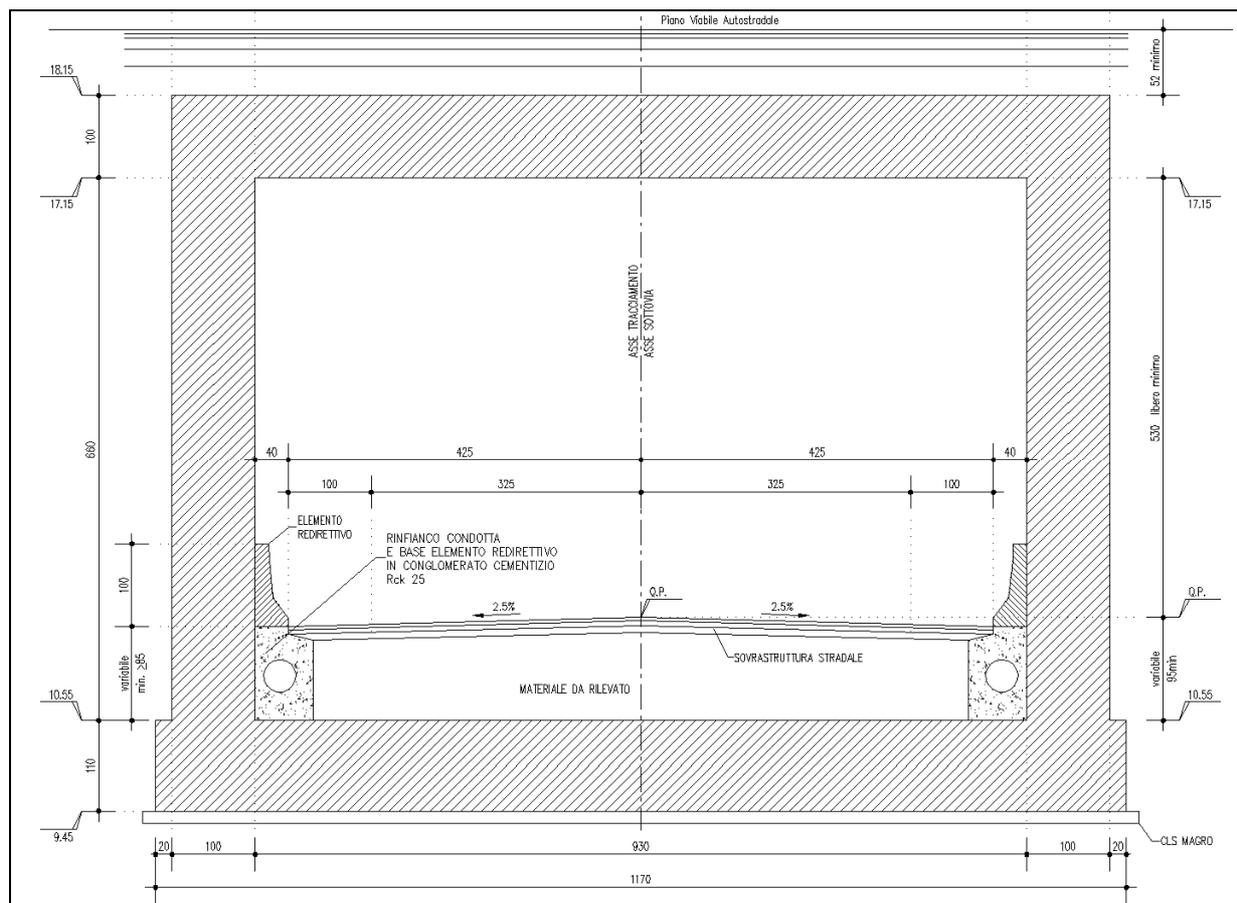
SEZIONE TRASVERSALE DEL SOTTOVIA
